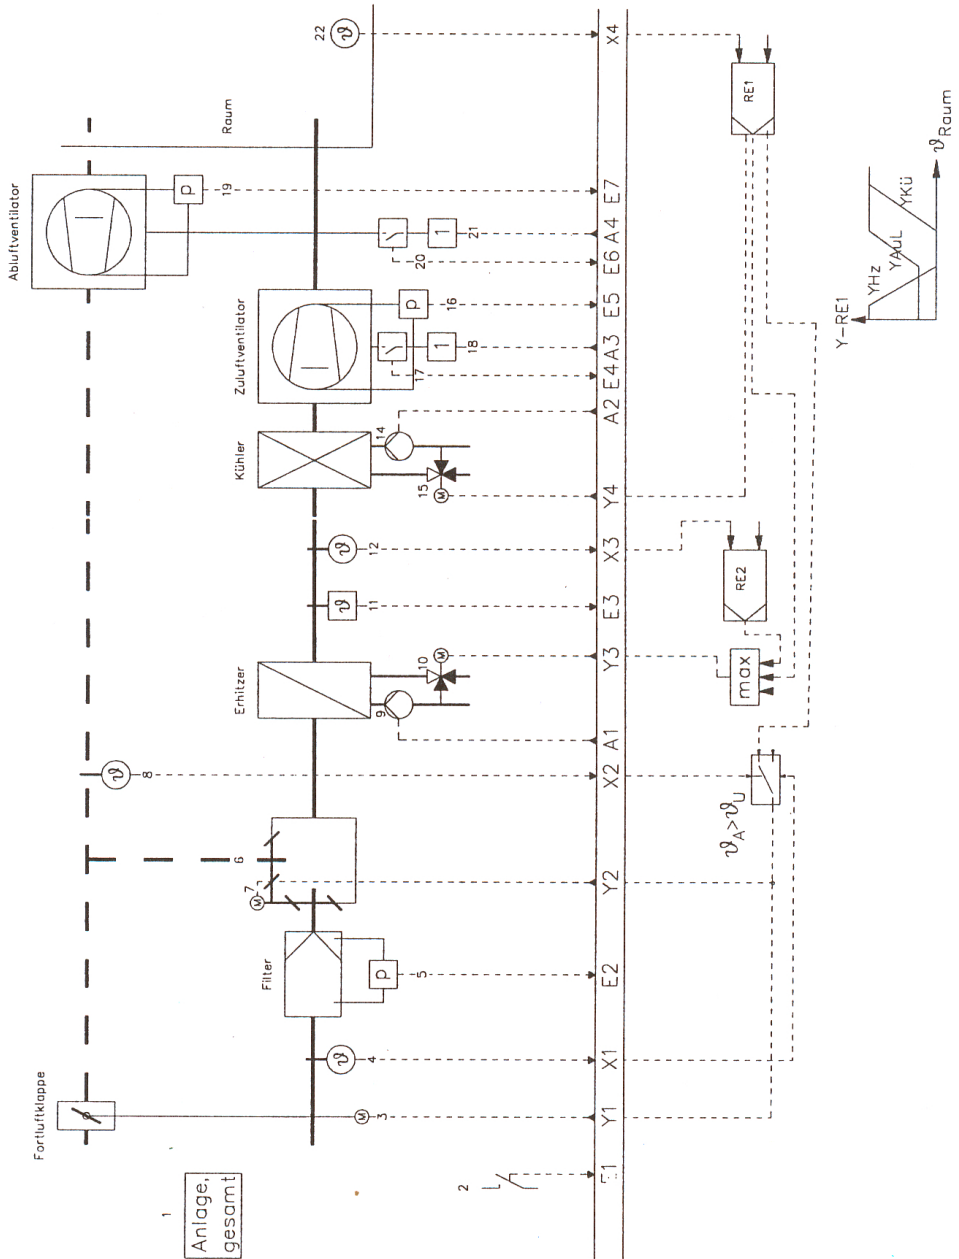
Automationsschema einer Mischluft-Lüftungsanlage
